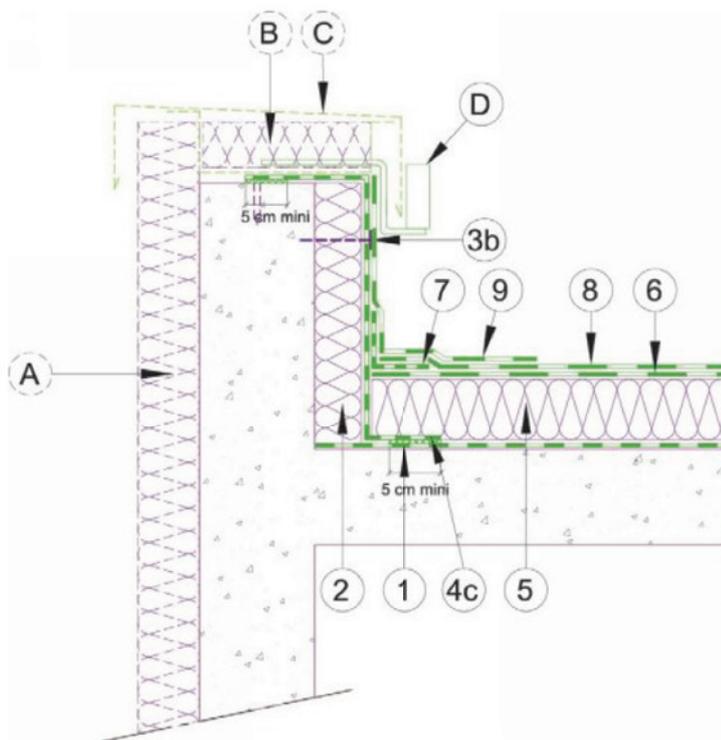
Relevé d'étanchéité sur isolant PUR, PIR apte à recevoir un revêtement autoadhésif – solution de base
